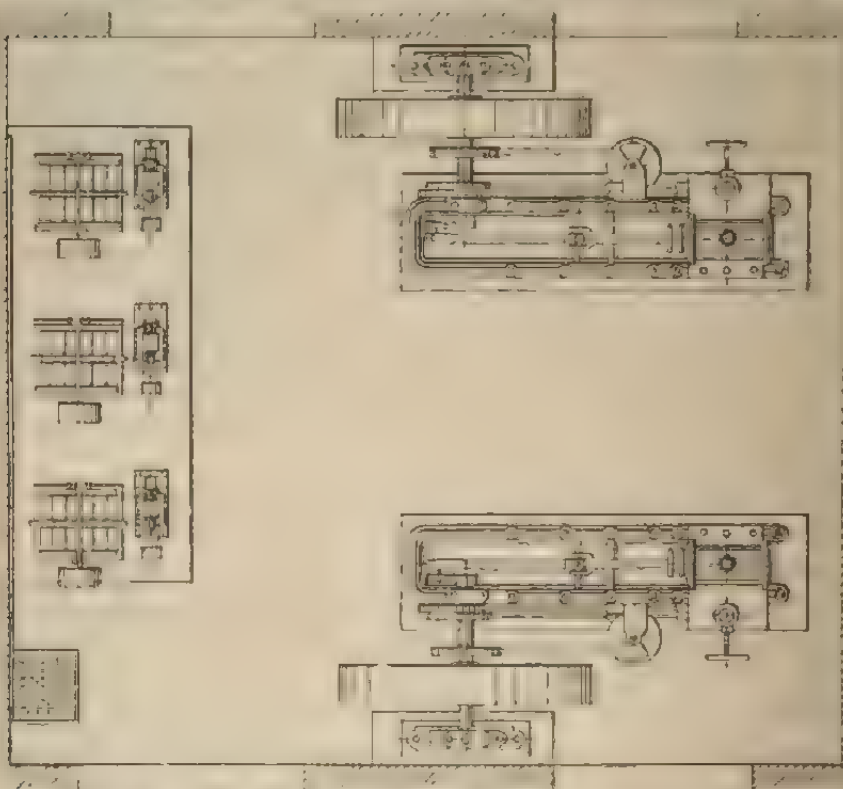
Grundriss des Maschinenhauses zur elektrischen Beleuchtung des Anhalter Bahnhofes in Berlin.
